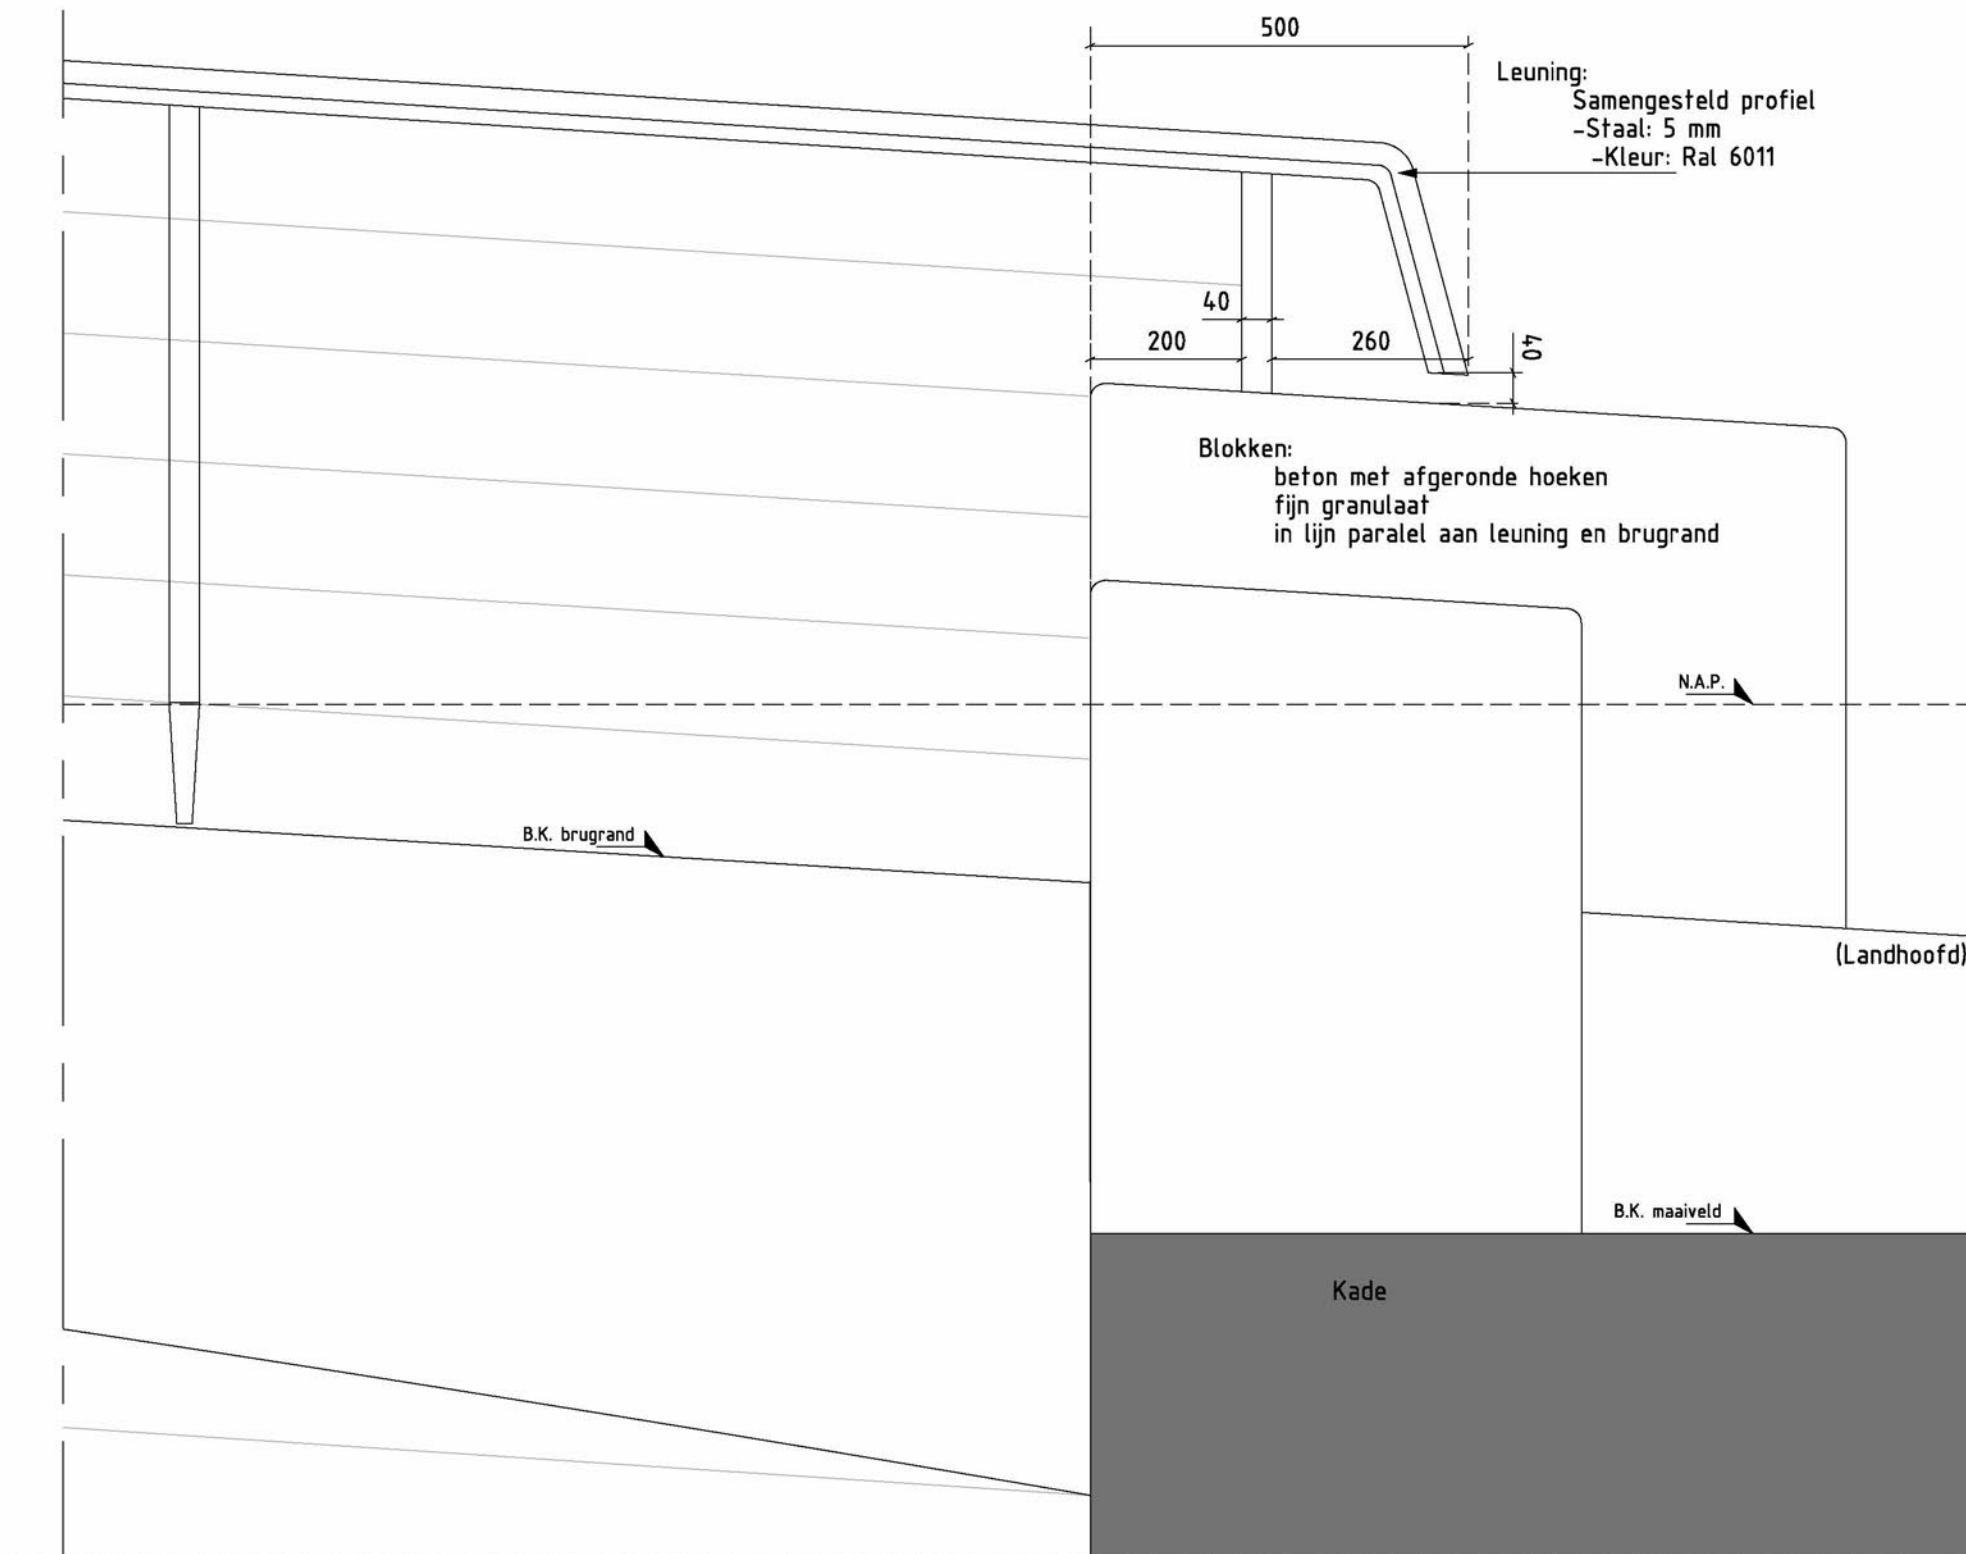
DETAILS - brugleuning A-01 - handrail en blok CNW-zijde
